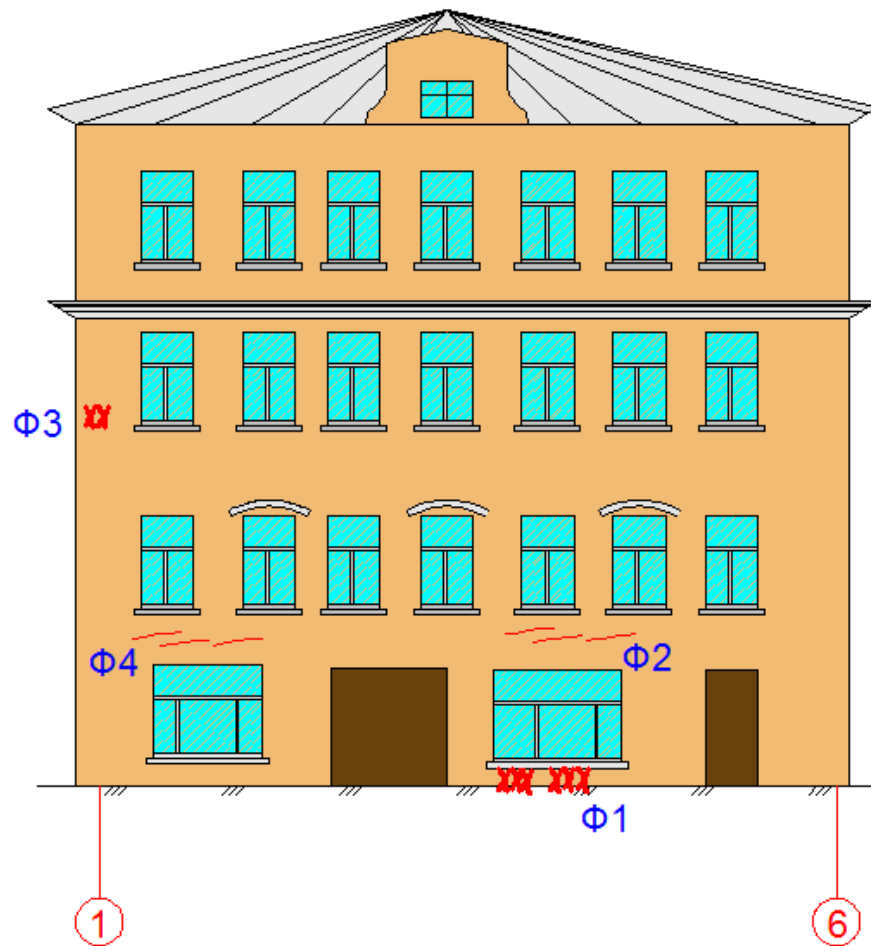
Схема дефектов фасад по оси «Е». Фасад со стороны _____ проспекта.
